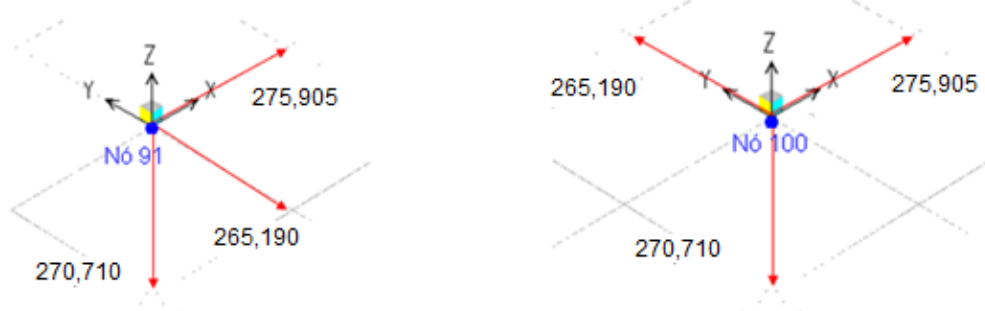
Carregamento dos pilares de sustentação da estrutura de cobertura – nó 91 e nó 100.
